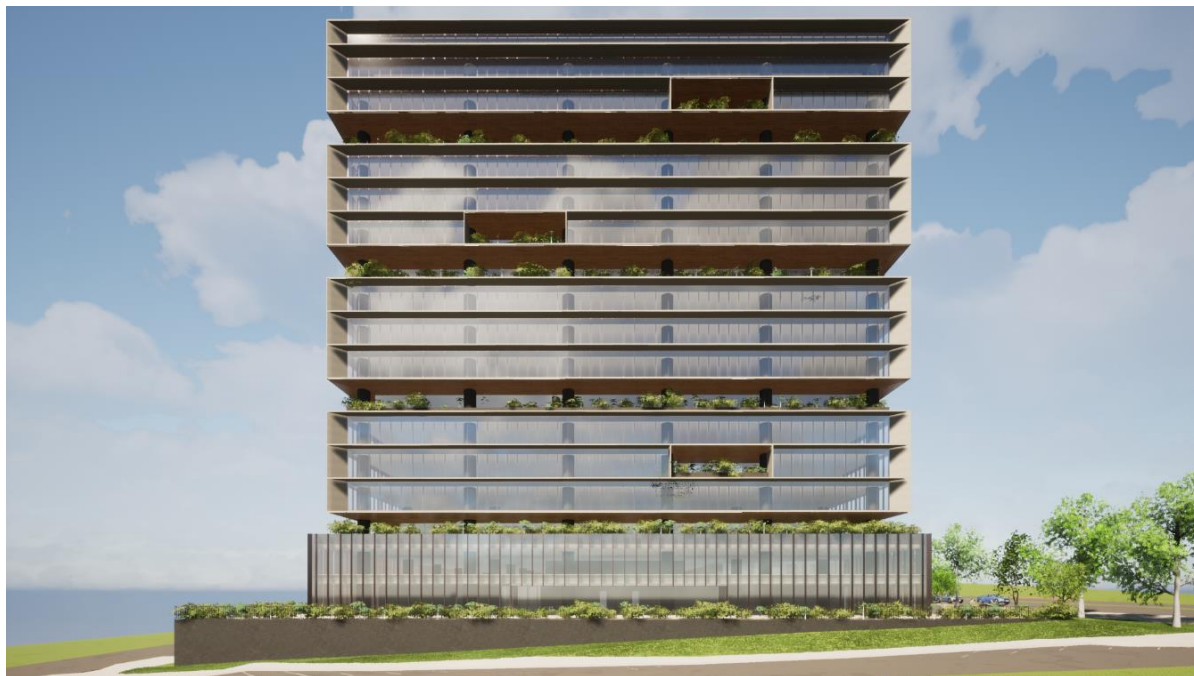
Imagem ilustrativa da fachada Norte. Fonte: Crosara Arquitetura.
